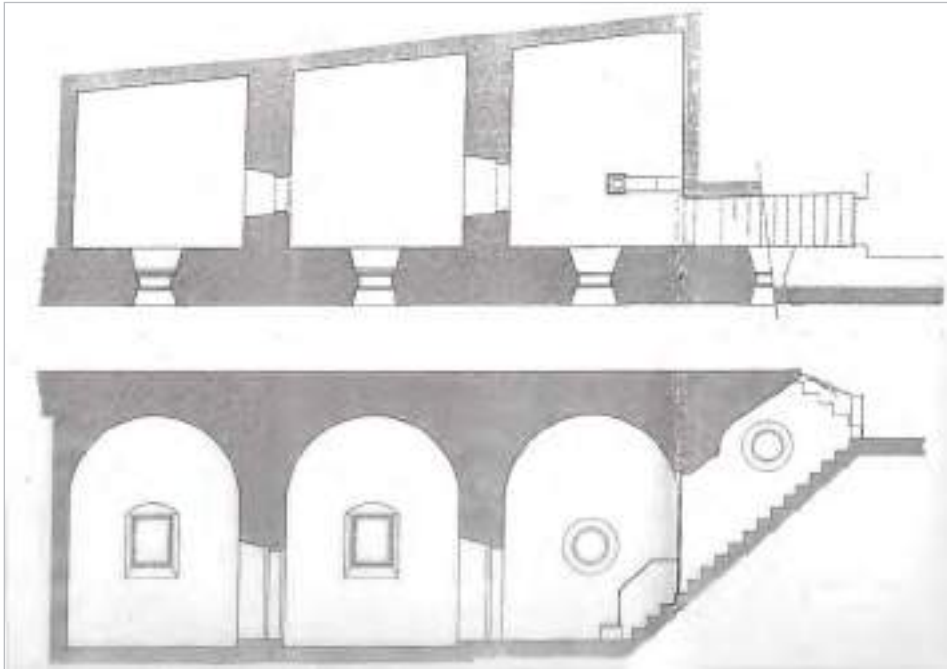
Planta y alzado de las denominadas oficinas (F. Cebrián)
